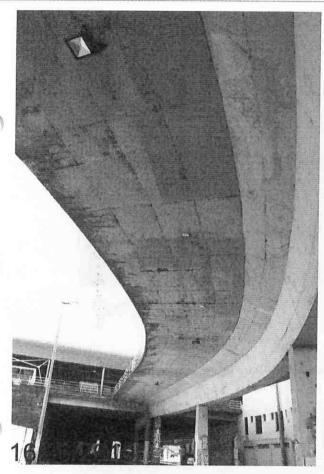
Detalhe de desplacamento do concreto, armadura exposta na viga principal.
